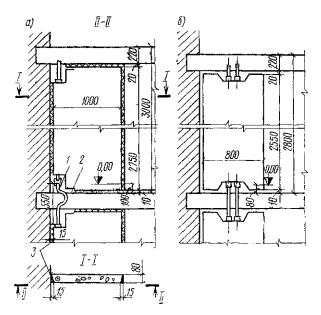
Установка и сопряжение перегородочных отопительных панелей
